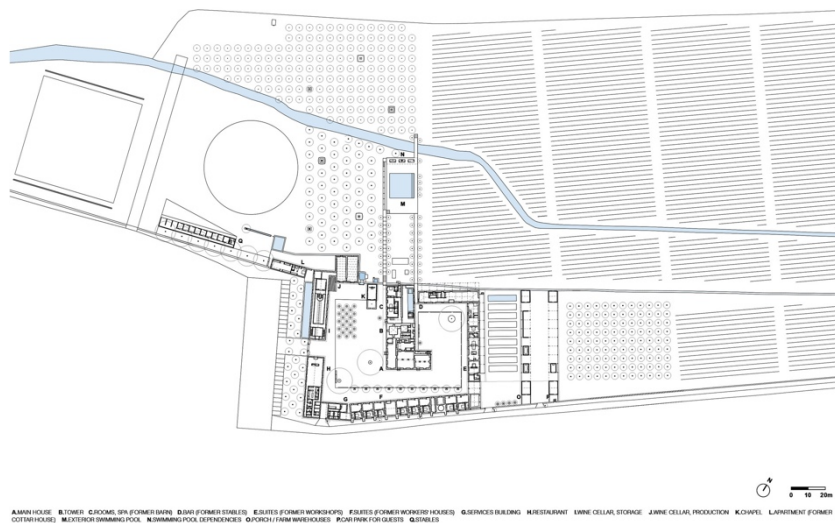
| Planta geral | Monforte | João Mendes Ribeiro | 2014
